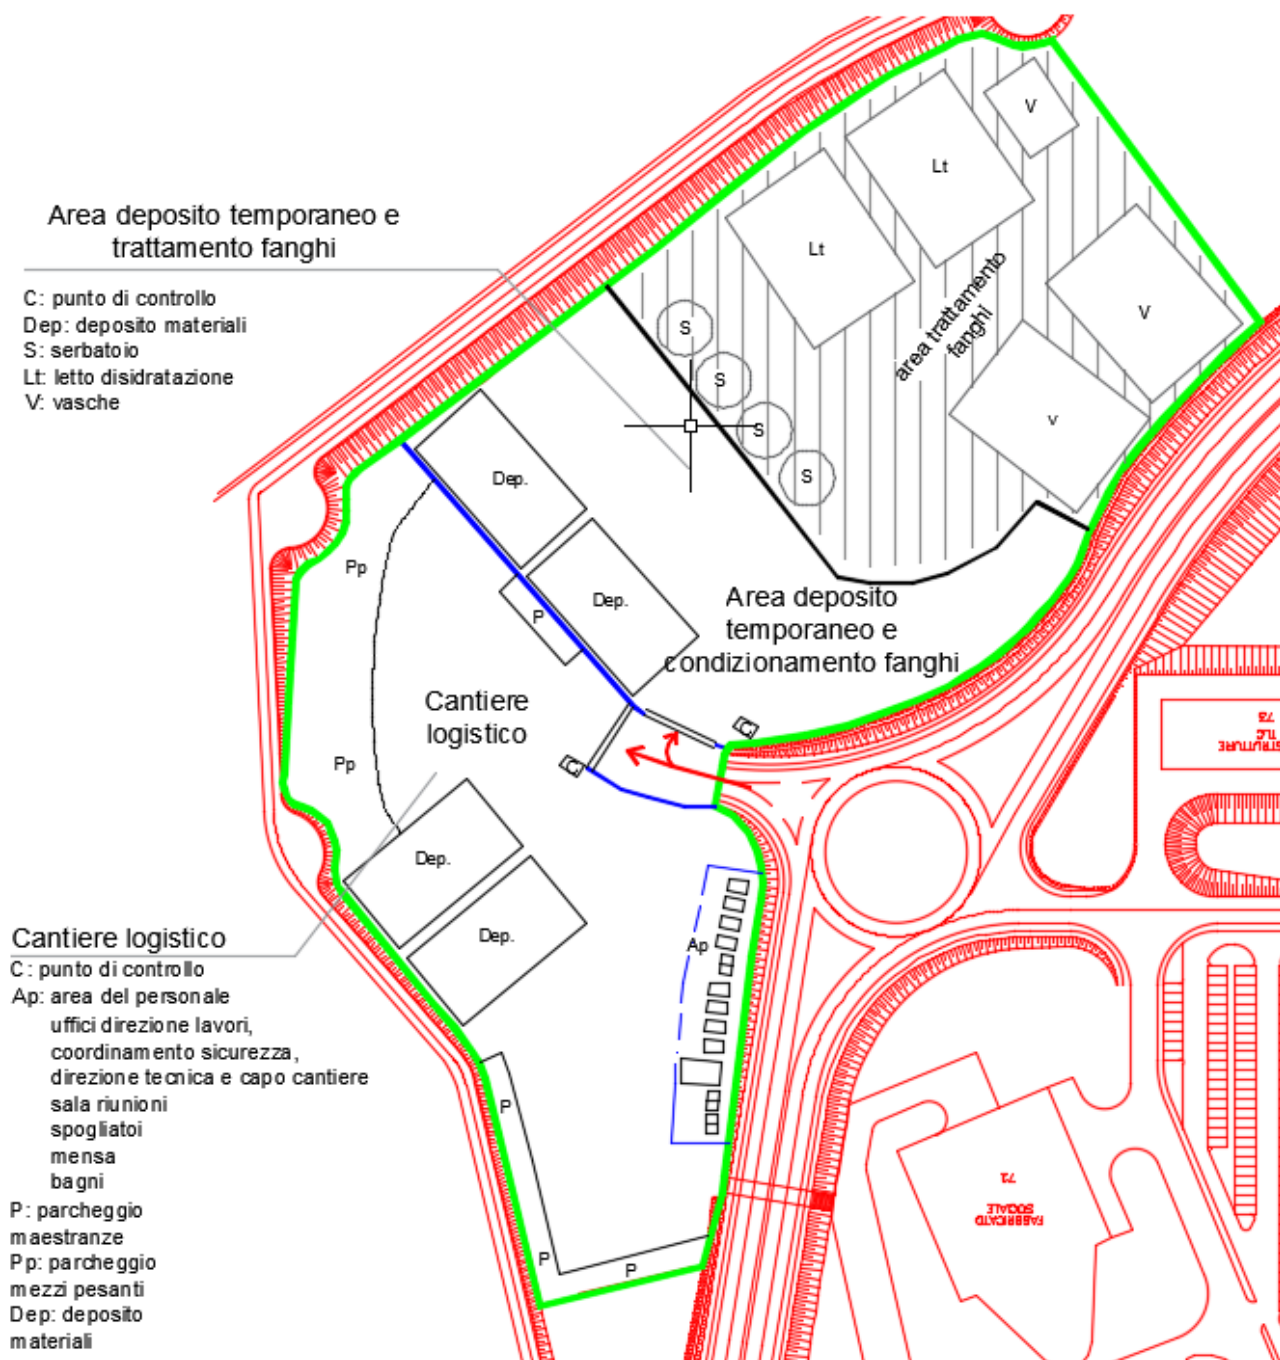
Cantiere logistico e area fanghi-dettaglio apprestamenti
